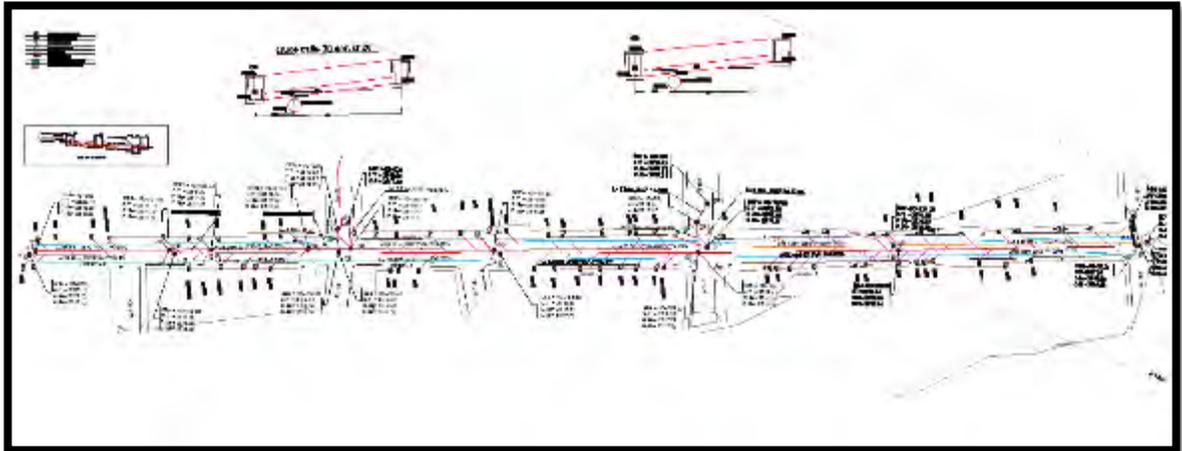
Planta de la red de alcantarillado tramo 4 (calle 20 entre carreras 27 y 30).
